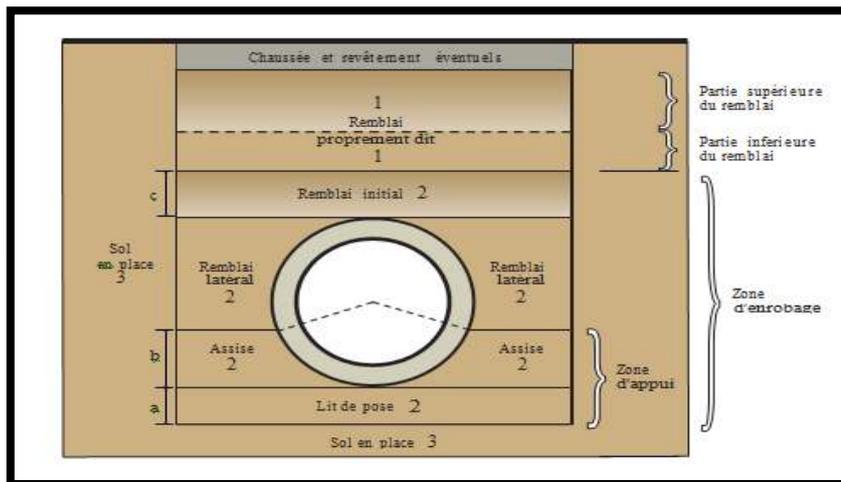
Coupe transversale d'une tranchée avec La mise en place de la conduite
